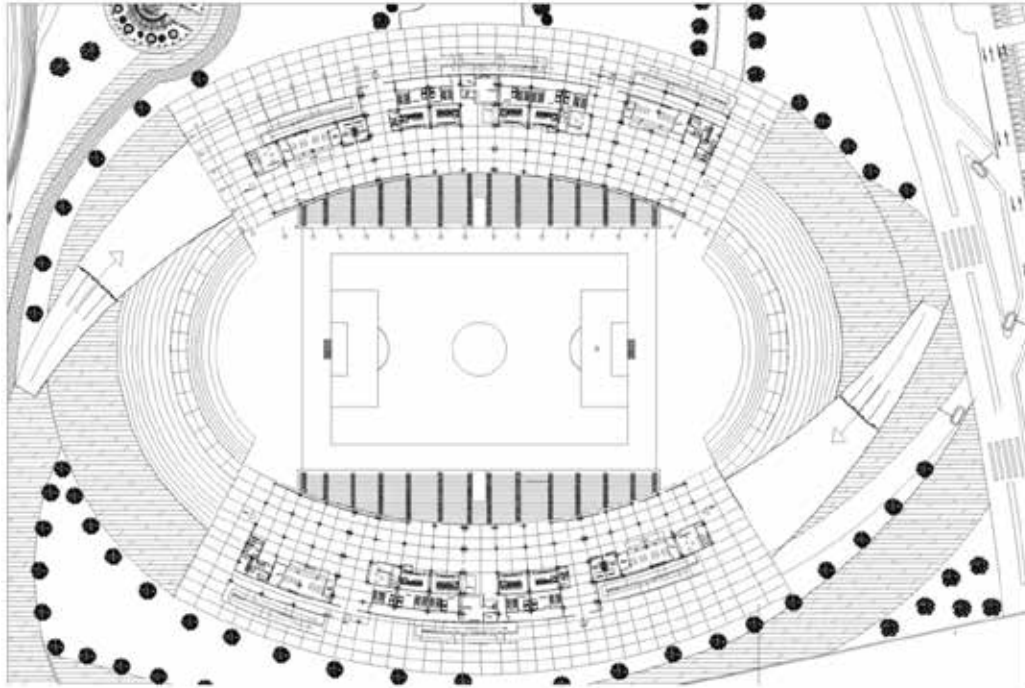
Planta Nivel +/-0.00, Planta Baja.
